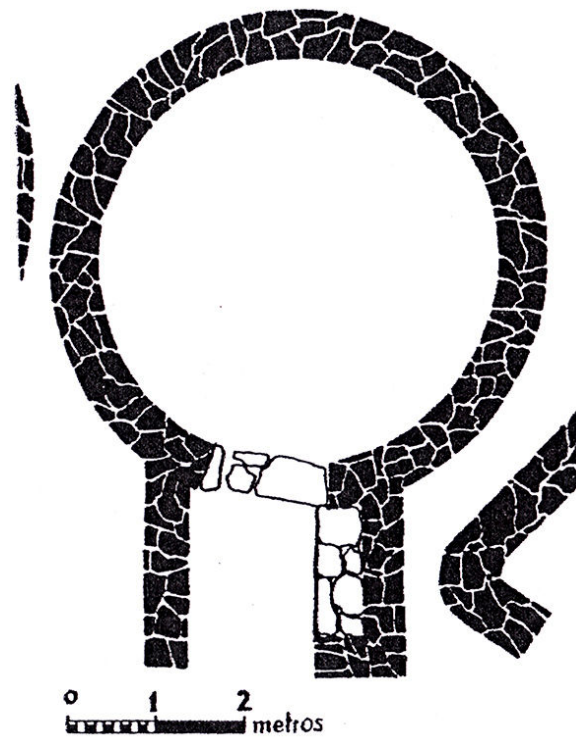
Planta de una vivienda del Castro de Coaña. Destaca el vestíbulo anexo a la entrada y el banco de piedra adosado a una pared del mismo. Plano realizado por D. Antonio García y Bellido.
